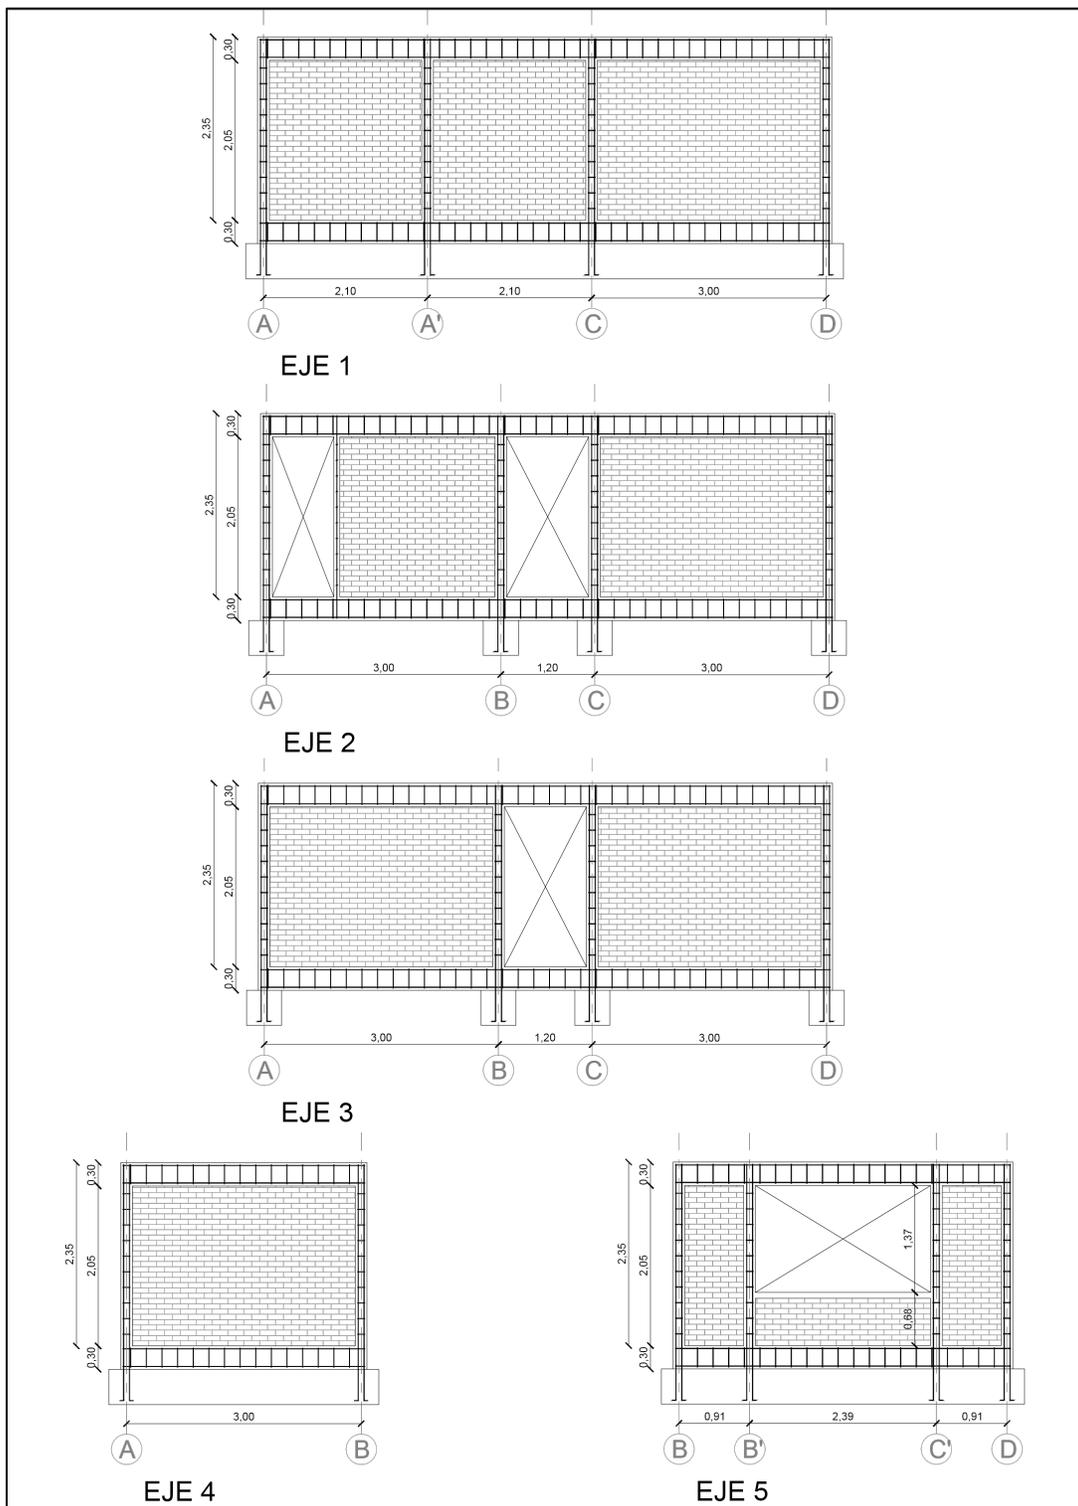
Elevaciones de estructuras modelo de albañilería confinada
